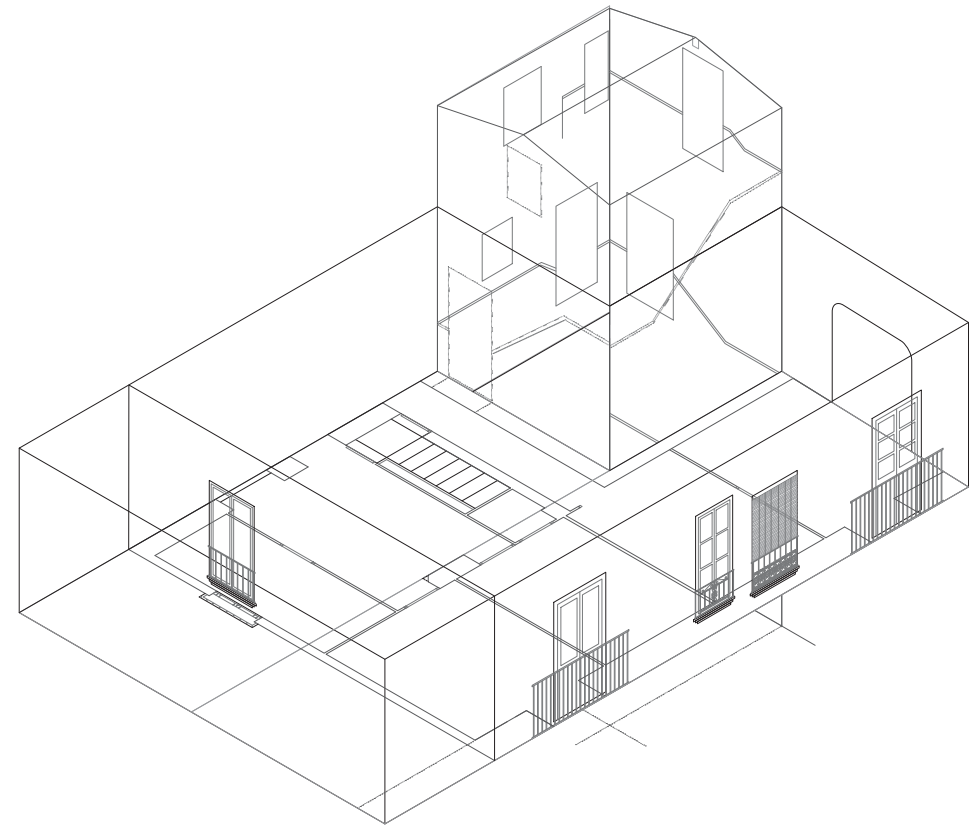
Distribución actual de la segunda planta (Fuente: elaboración propia)
